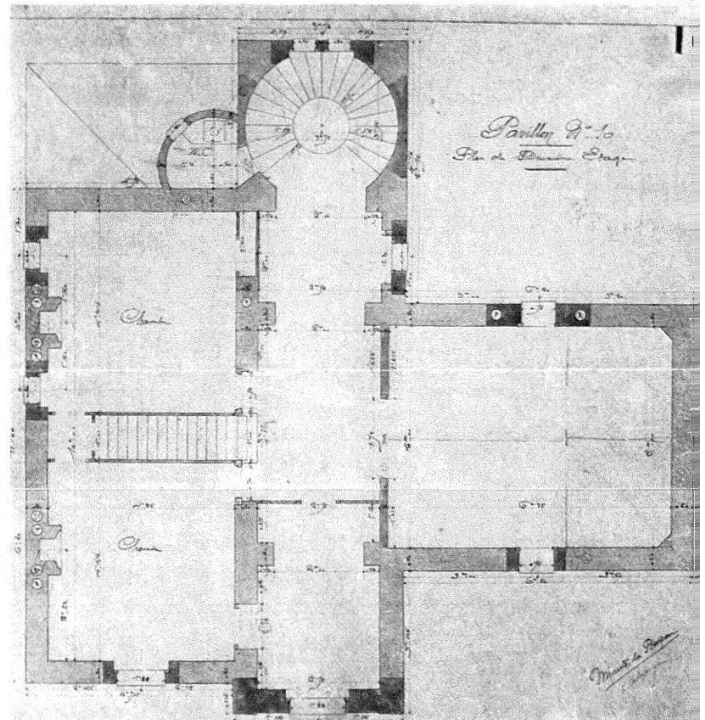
Pavillon n° 10, plan du deuxième étage, réservé à la vie privée. Large vestibule central branché sur l'escalier et les privés. Suite de deux chambres à l'ouest
